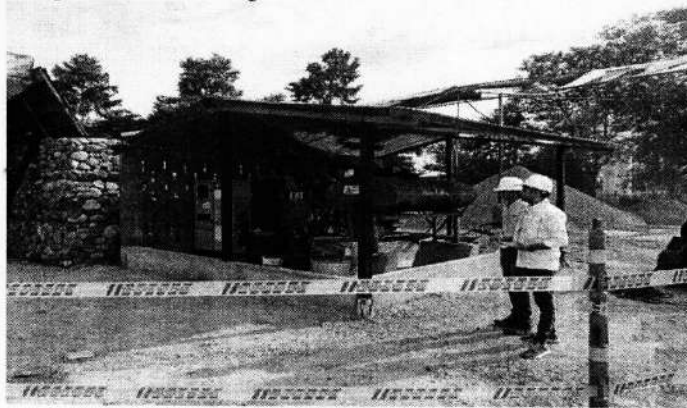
Vista general área planta generadora de energía eléctrica, construcción de diques y piso duro en concreto.
